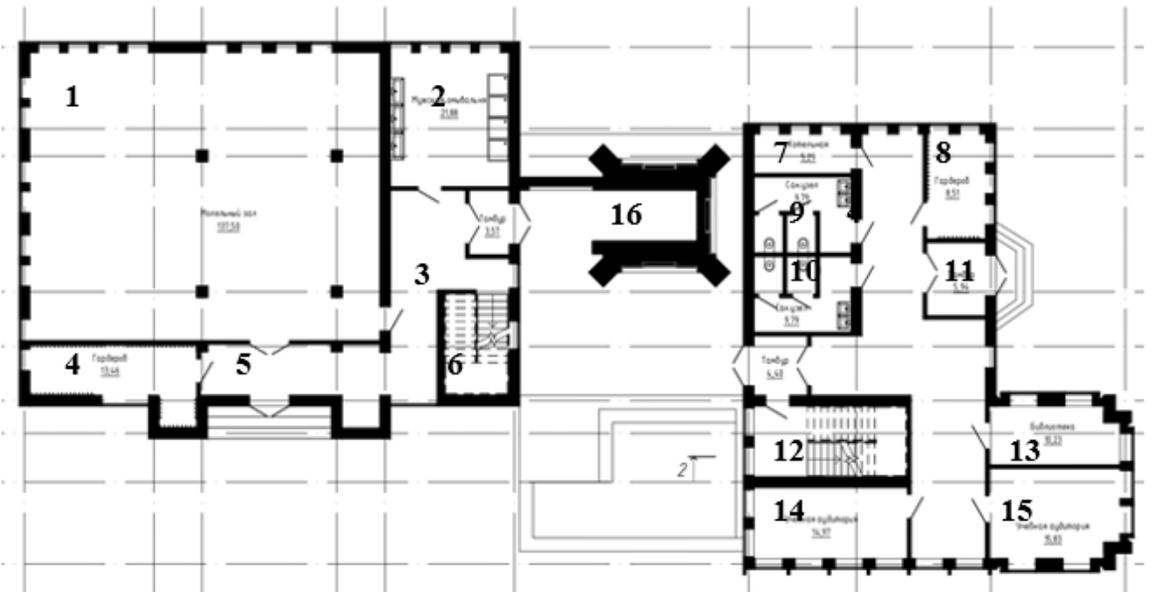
Схема плана первого этажа комплекса мечети: 1 – мужской моляльный зал; 2 – мужская комната для омовения; 3 – коридор; 4 – гардероб; 5 – холл; 6 – лестница; 7 – котельная; 8 – гардероб; 9, 10 – санузел; 11 – тамбур; 12 – лестница; 13 – библиотека; 14, 15 – учебные аудитории; 16 – минарет
